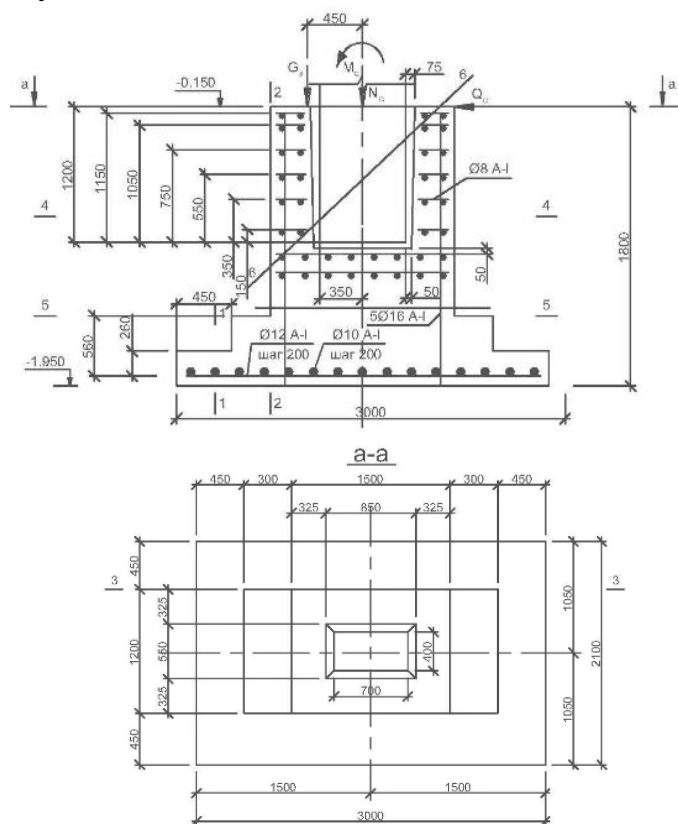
Схема армирования столбчатого фундамента под сборную железобетонную колонну
